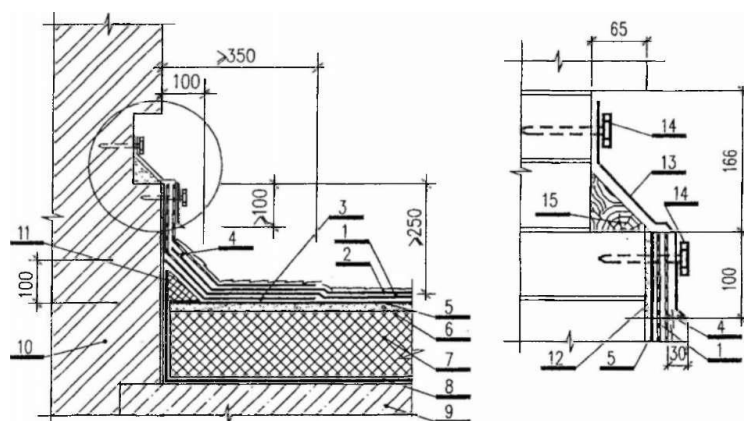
Примыкание двухслойной кровли с подведением под выдру при сплошной наклейке водоизоляционного ковра
